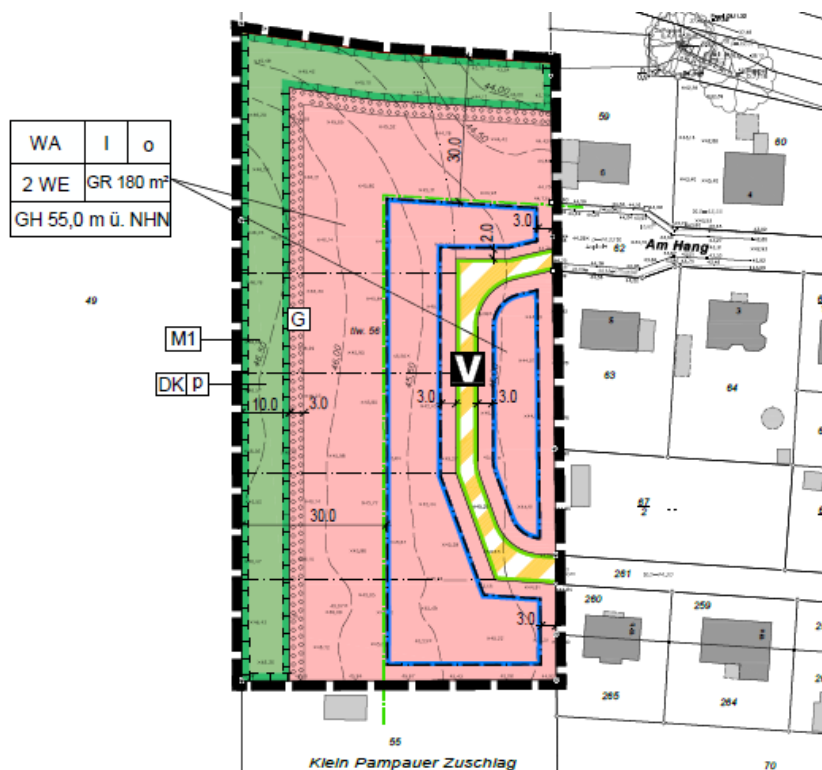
Ausschnitt aus der Planzeichnung zum B-Plan (PROKOM 2025)
